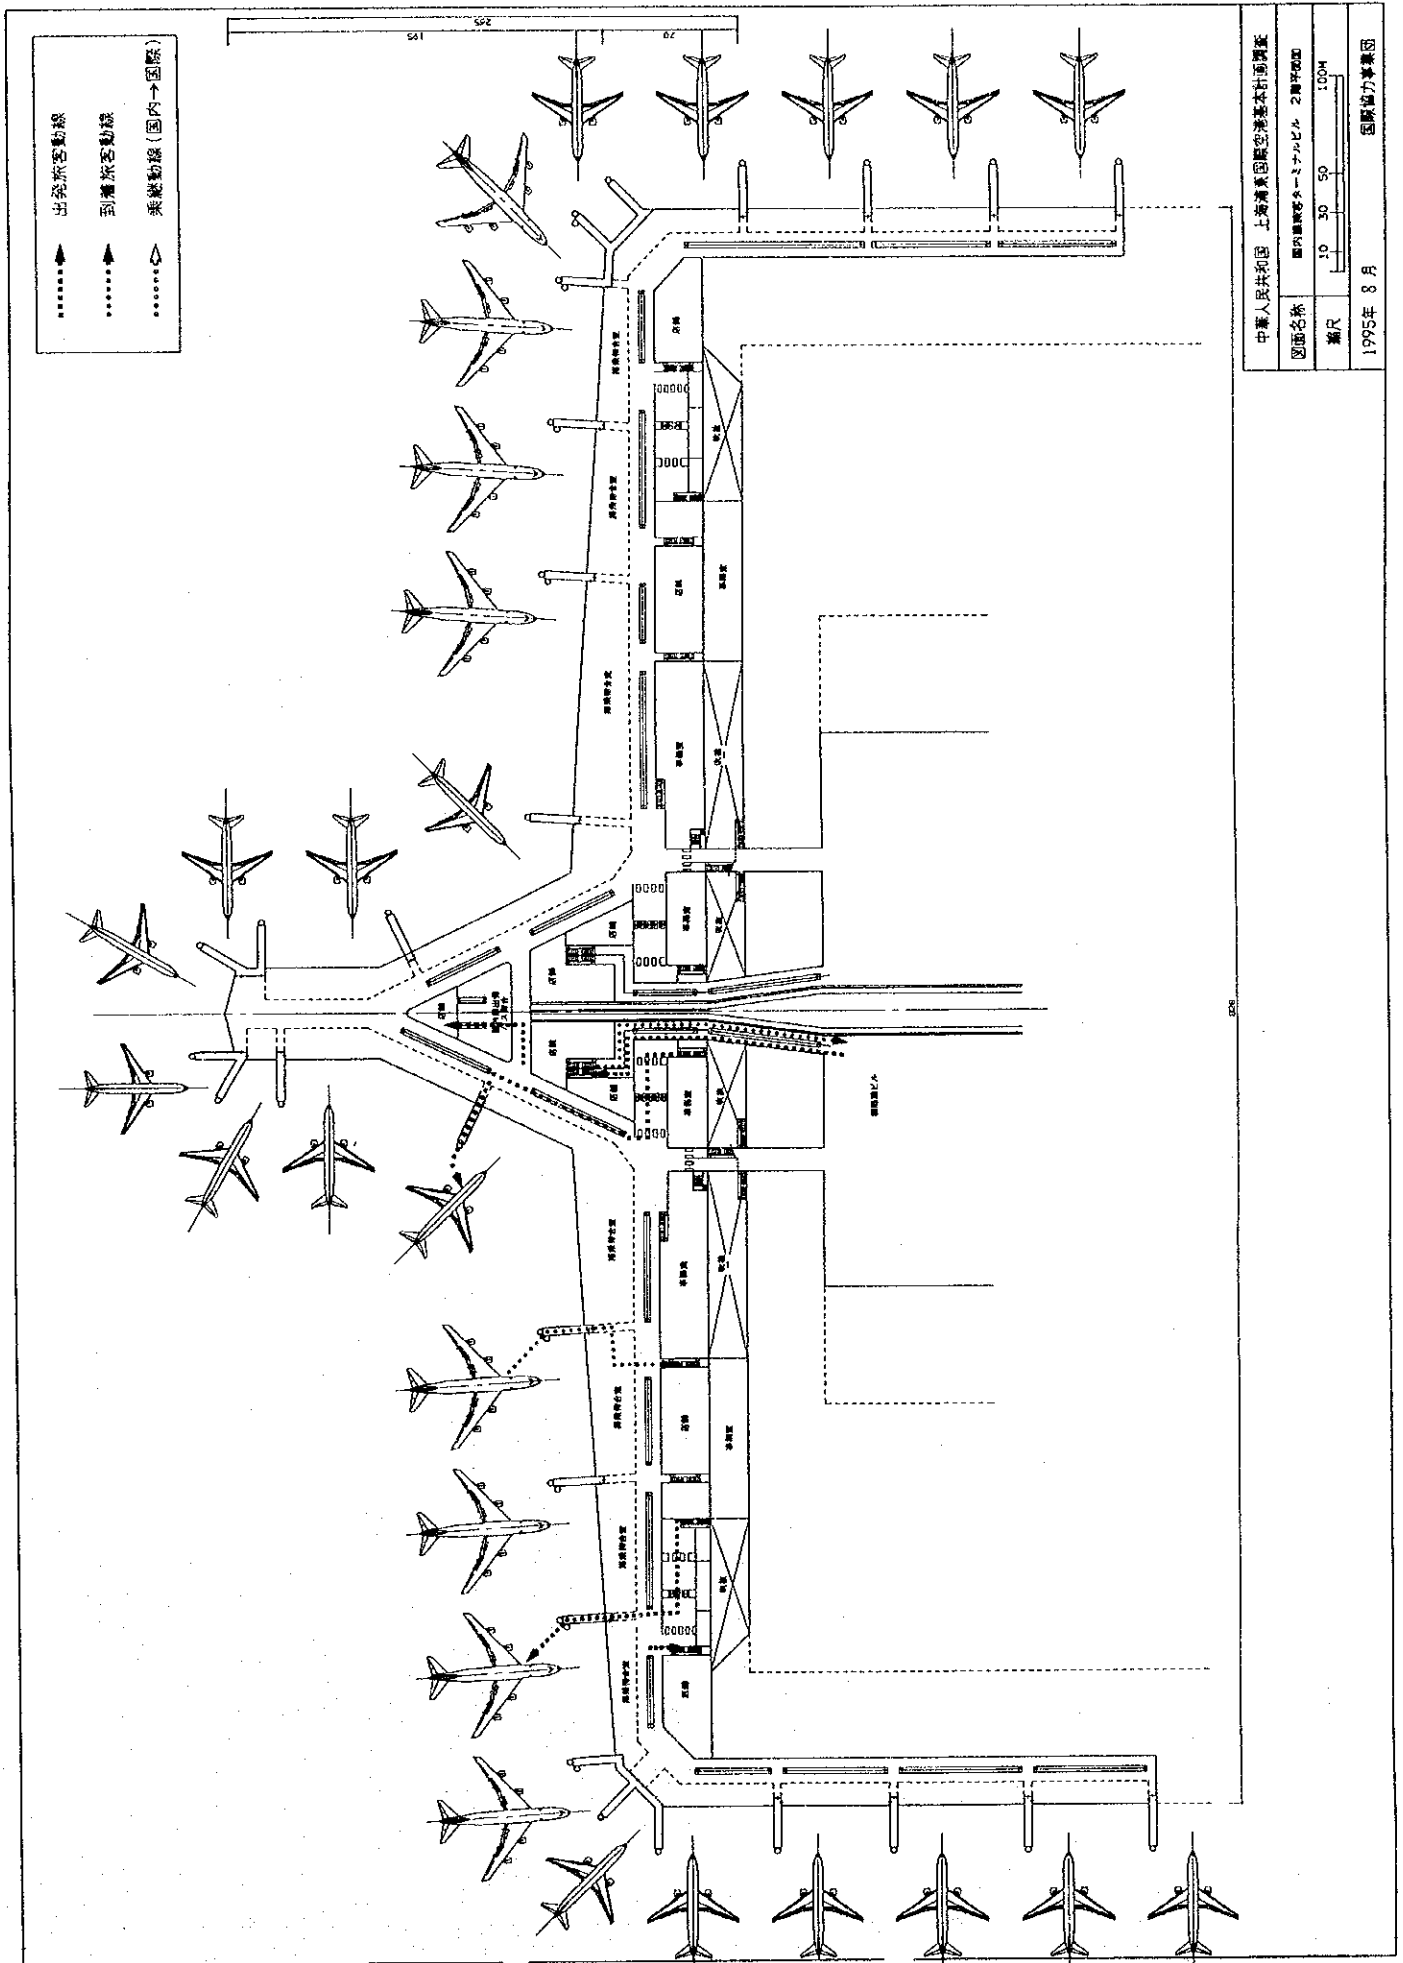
国内線旅客ターミナルビル 1階平面図
